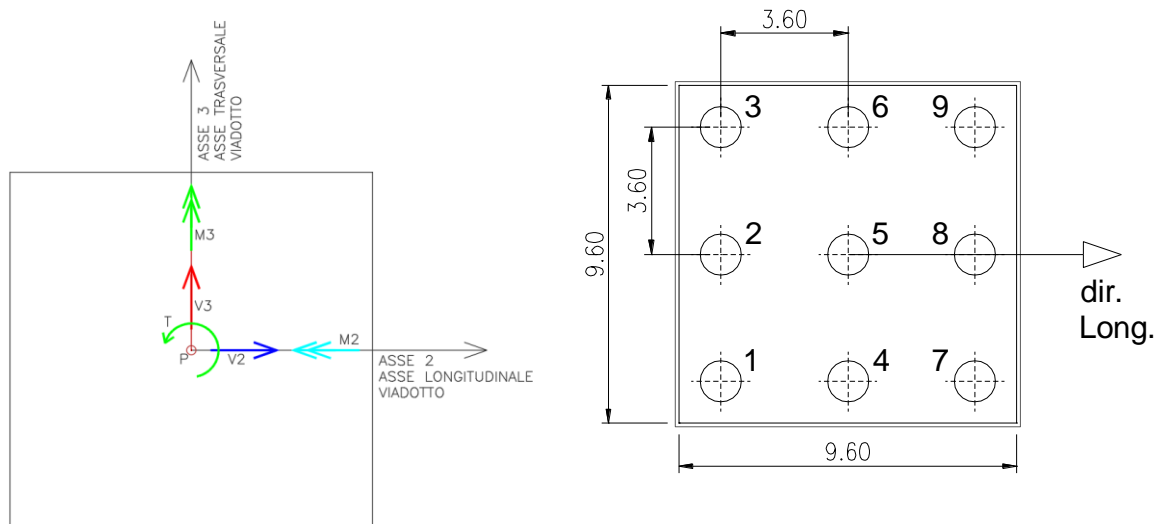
V01 – SPALLE SP1 e PILE – pianta plinto e convenzione dei segni delle azioni agenti.
